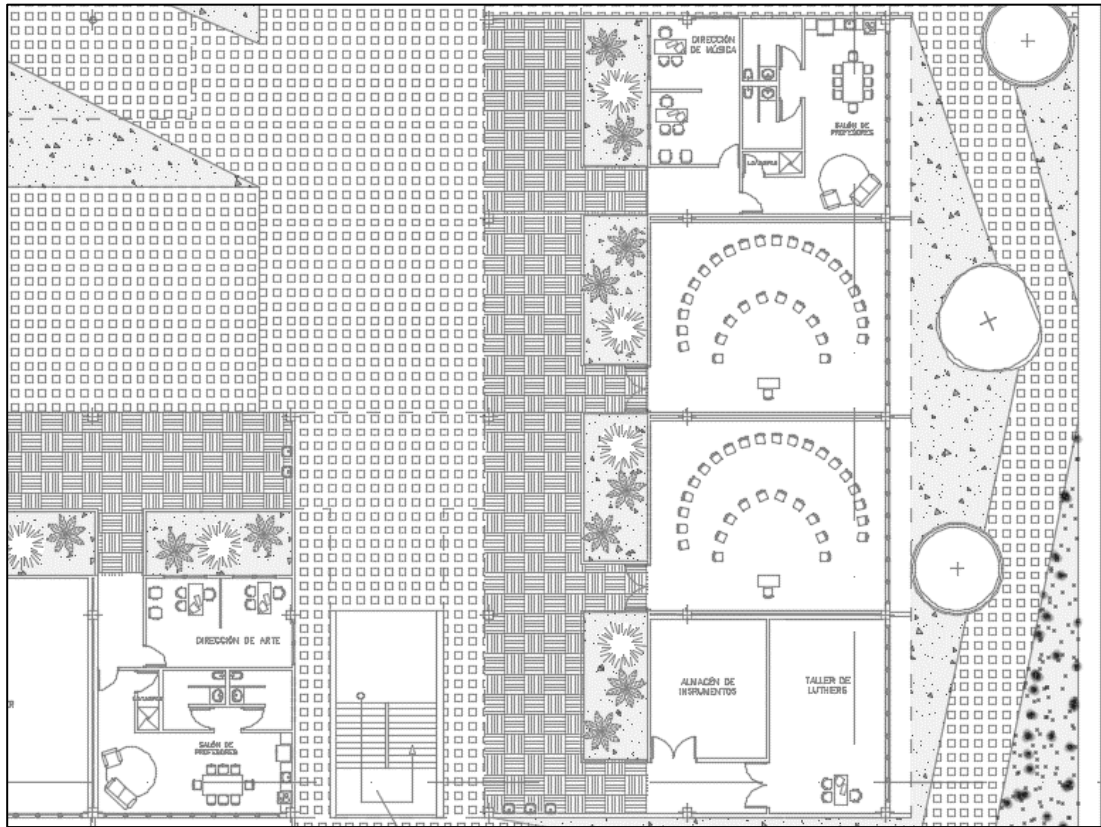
Planta Baja Modulo Musical. Fuente: Propia autoría. (2018).
